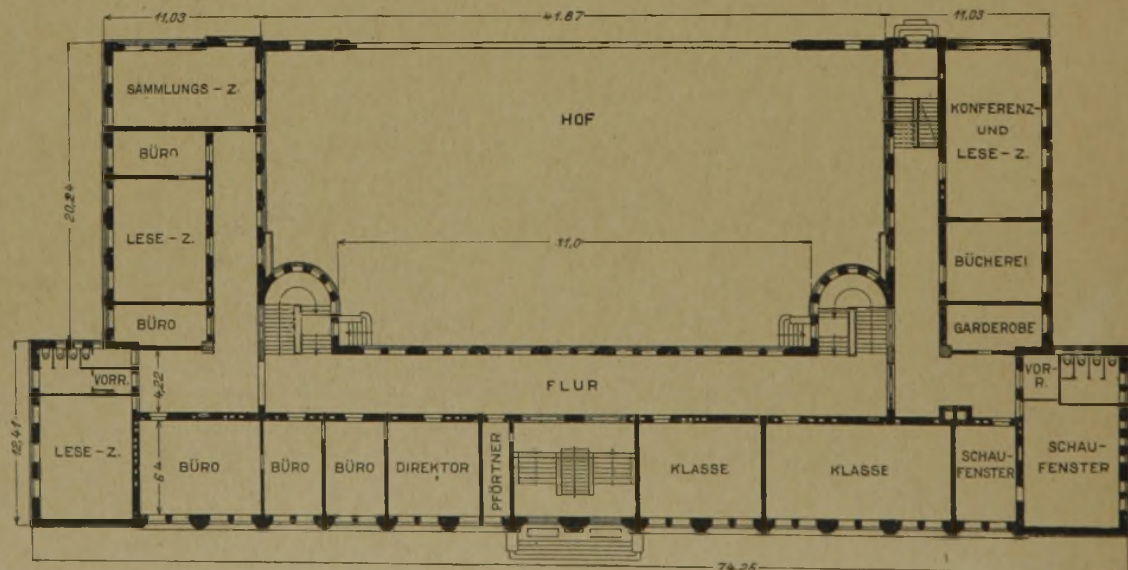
Grundriß des Erdgeschosses. (1:500)
